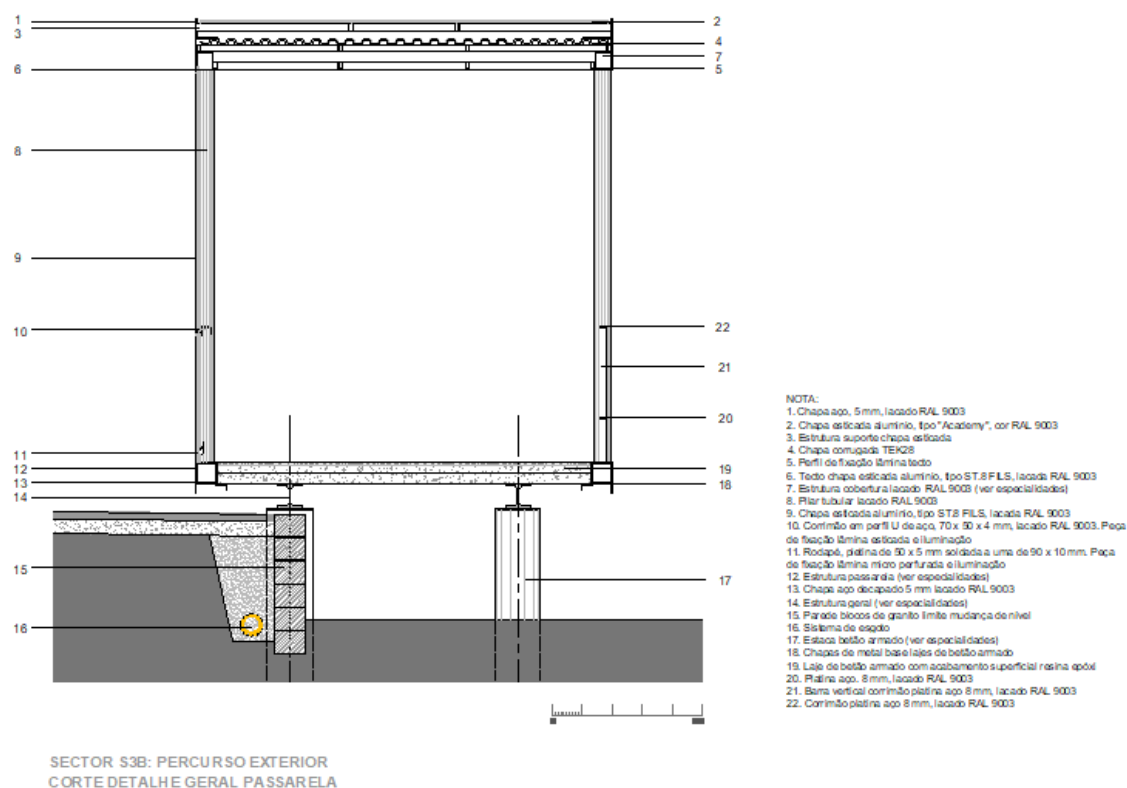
Corte Percurso Exterior - Detalhe Geral Passadiço
